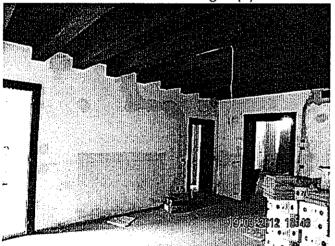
Stanza 8- Vista parete lato androne e porte accesso.
